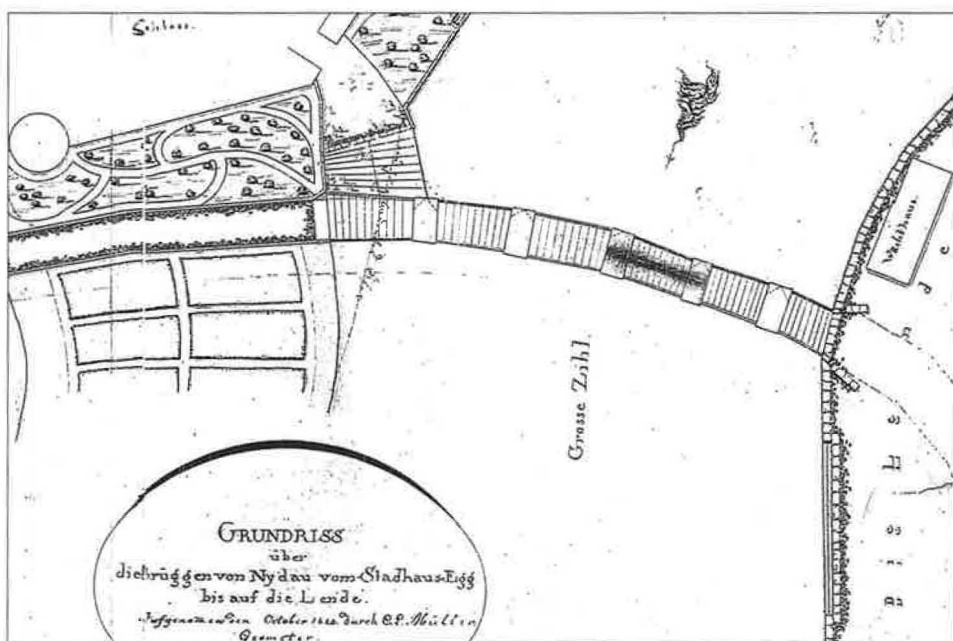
Ausschnitt aus dem Grundrissplan von Geometer C.L. Müller, aufgenommen im Oktober 1824, Massstab in Bern Fuss, STAB Br. 544. In der Bildmitte die ca. 53 m lange Zugbrücke, auch Fallbrücke genannt, mit fünf steinernen Pfeilern. Gut sichtbar ist die Fahrbahn mit den quer gelegten Laden. Bekanntlich mussten die Bewohner aus Ilfingen (Orvin) und auf dem Tessenberg seit dem 13. Jahrhundert alle 7 Jahre einen Laden (14 Schuh lang, 1 Schuh breit, drei Finger dick) für die Brücke in Nidau abliefern (s. S. 6). Die Breite der Fahrbahn beträgt umgerechnet ca. $4\frac{2}{4},3$ m und entspricht somit der Länge von 14 Schuh der quer gelegten Brückenladen. Daraus kann geschlossen werden, dass die Breite der Brückenfahrbahn über 500 Jahre unverändert war. Am Brückende gegen das Schloss zweigt eine kleine Brücke zum Schloss-Tor ab, das zusätzlich durch eine kleine Zugbrücke (existierte 1824 nicht mehr) abgesichert war (s. Abb. 10a). Am westlichen Ufer der Grossen Zühl ist ganz schwach eine neue Uferlinie projektiert. Bauliche Veränderungen müssen um 1826 vorgenommen worden sein (Abb. 13,14,15).
